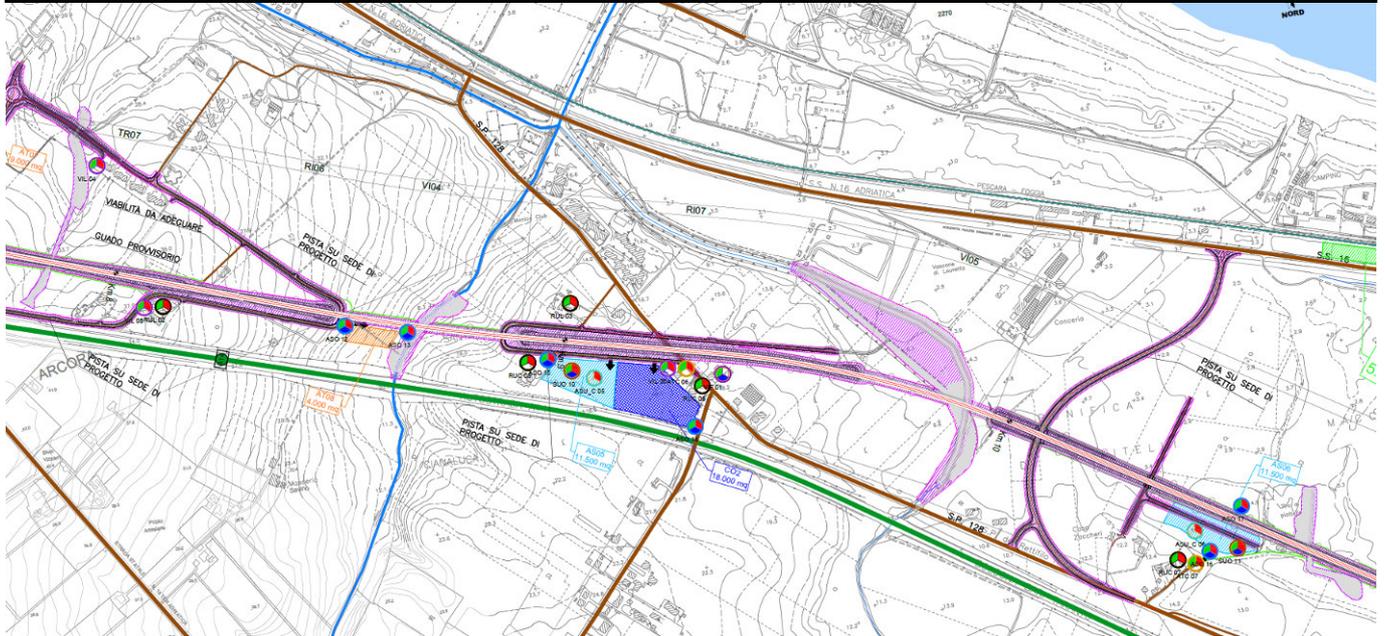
Stralcio Planimetria localizzazione punti di monitoraggio tav 4/9 (PK 10+830)
